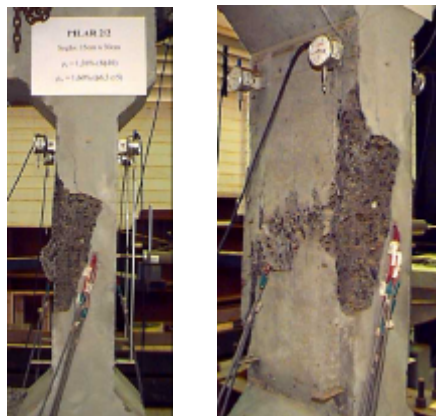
Forma de ruptura do pilar P2/2
